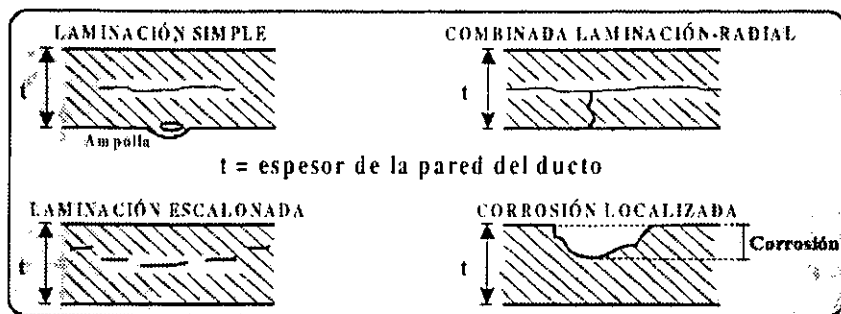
Daños por corrosión que puede sufrir un ducto
